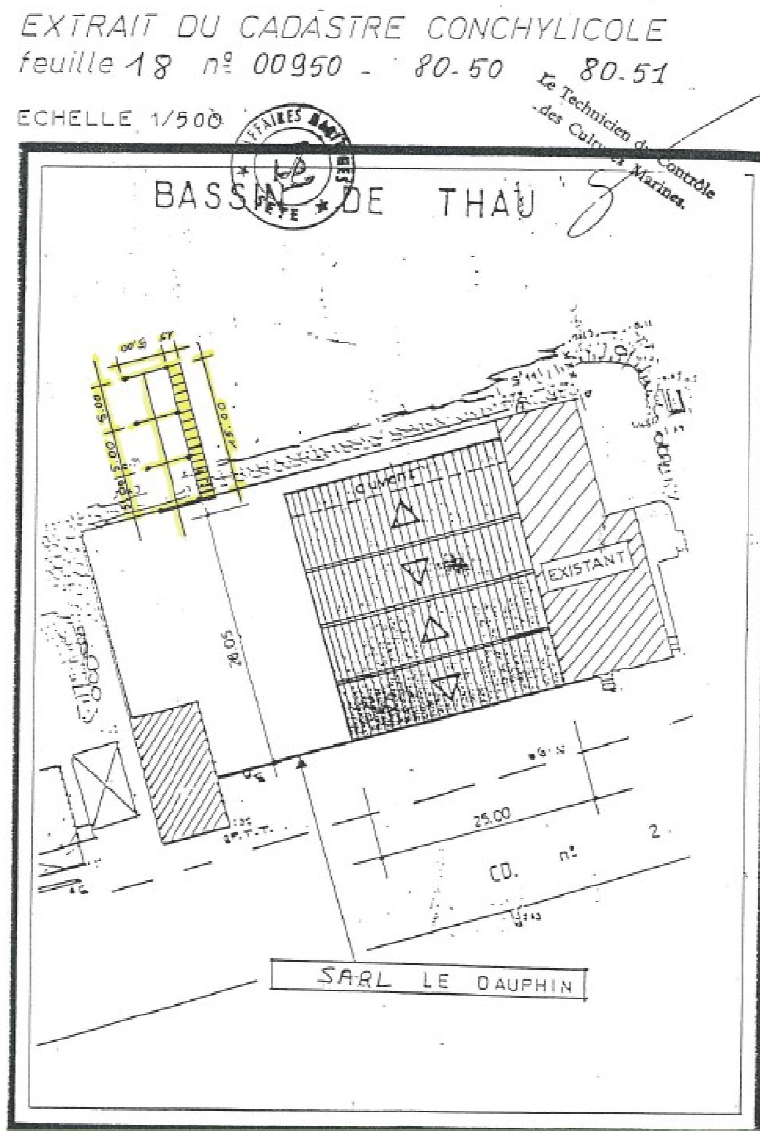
Plan d'une concession conchylicole obtenu lors d'un entretien à la DML 34
